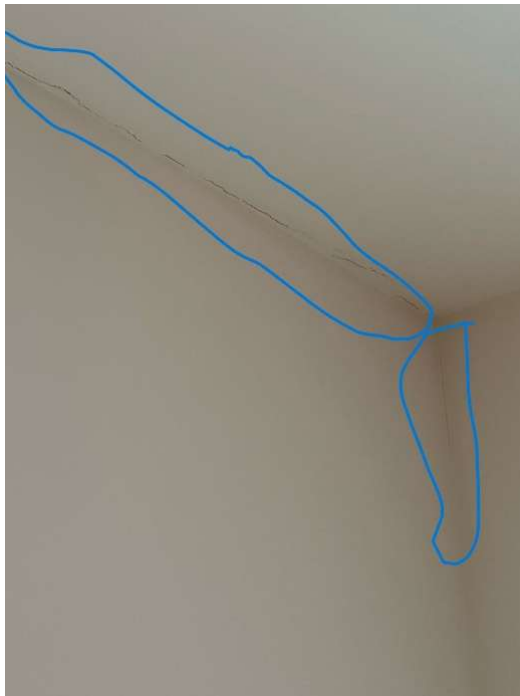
Fissura de retração – Caso de estudo 1
